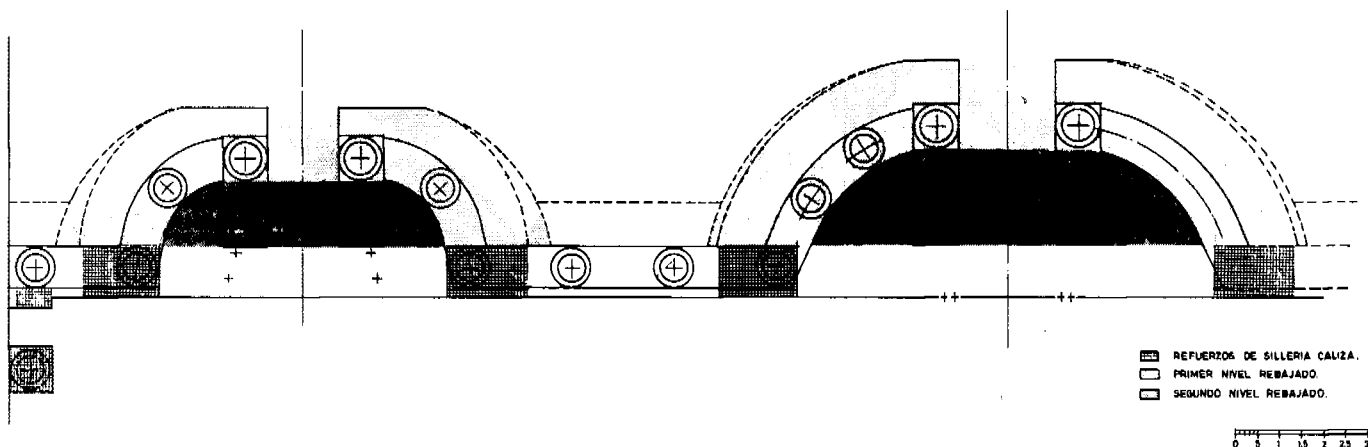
Planta de la escena con una posible distribución de columnas: hipótesis de restitución.
